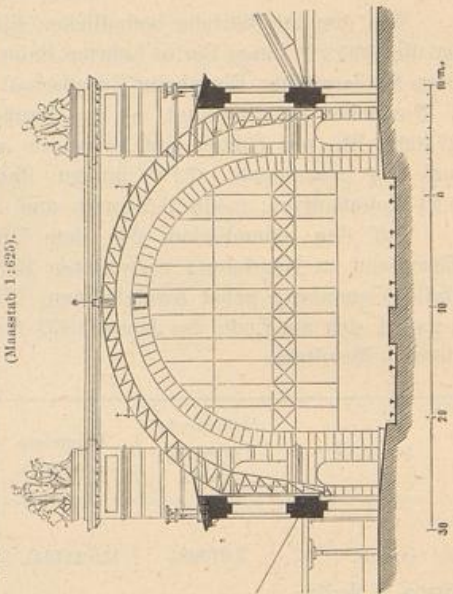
und 66. Empfangsgebäude der Berlin-Lehrter-Eisenbahn. Hauptfacade und Querschnitt durch die Halle. (Maassstab 1:6250).
